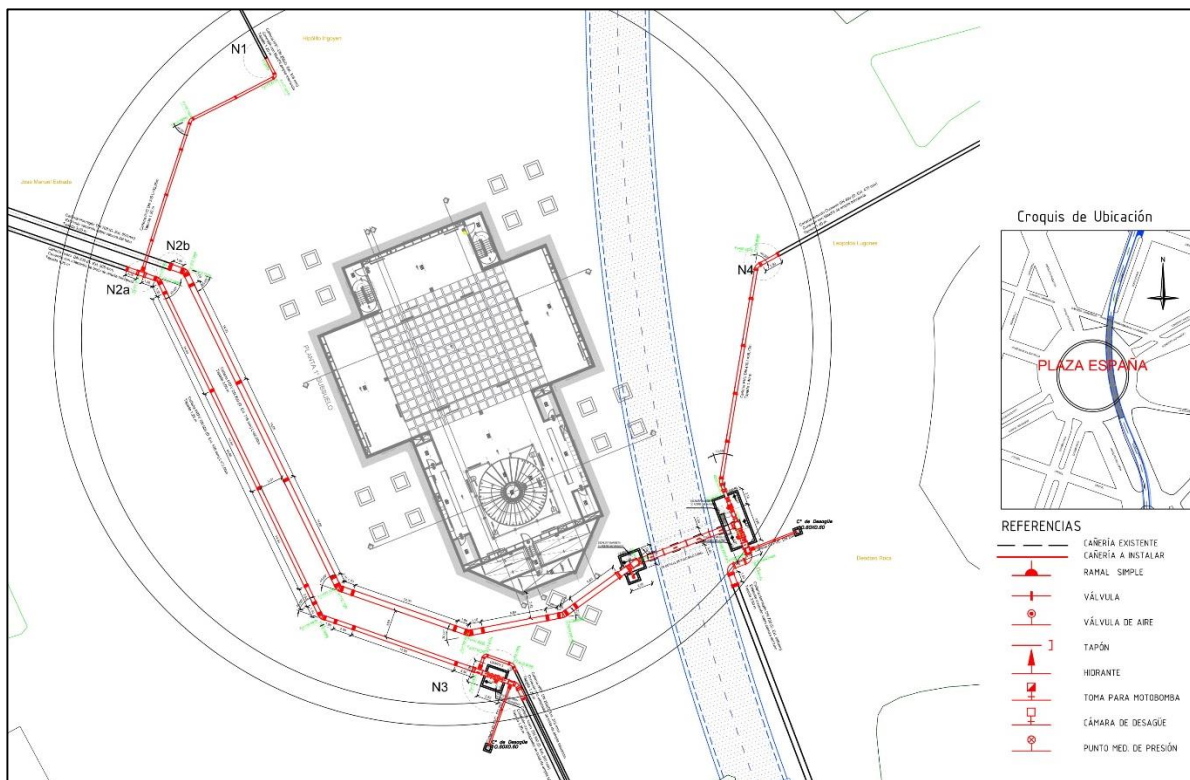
Planimetría del proyecto ejecutivo del desvío de la red de agua. (PLANO N° 15)
